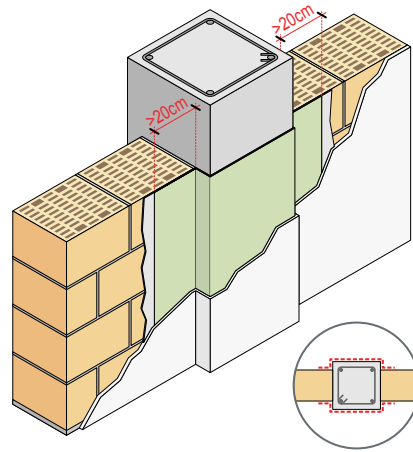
Encuentro de una separadora Silensis Tipo 1A con un pilar sin cajeado. Colocación de las bandas de refuerzo.
